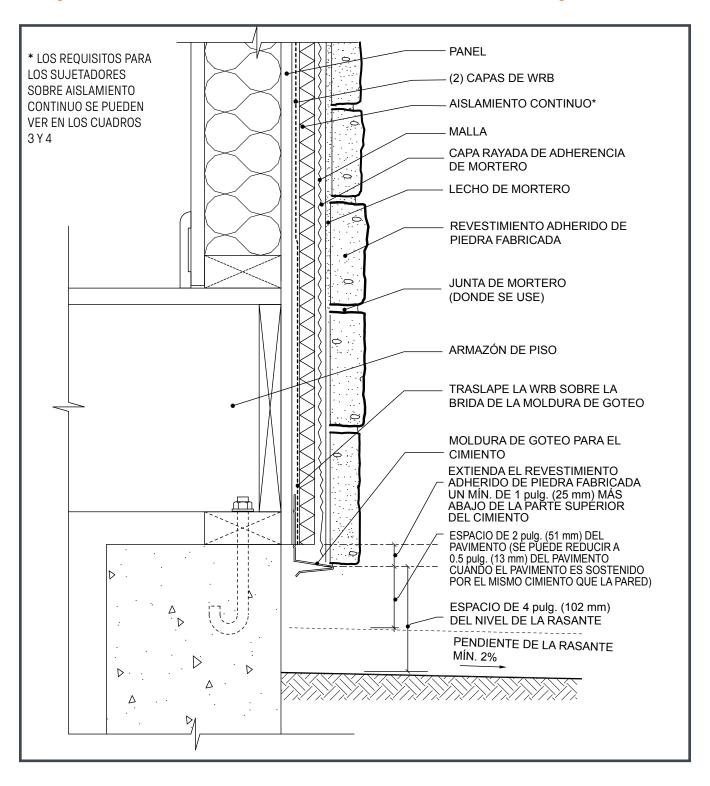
Base de muro de cimentación-AMSV superpuesto sobre el cimiento
